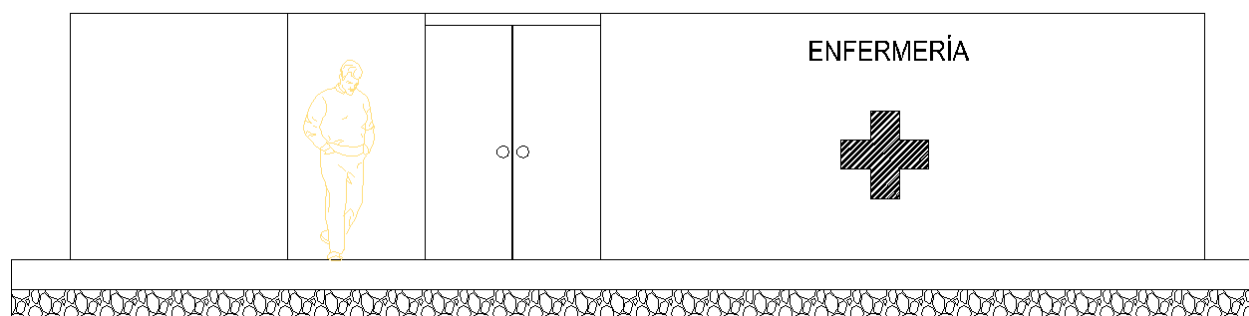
Fachada frontal derecha Aulas/talleres
